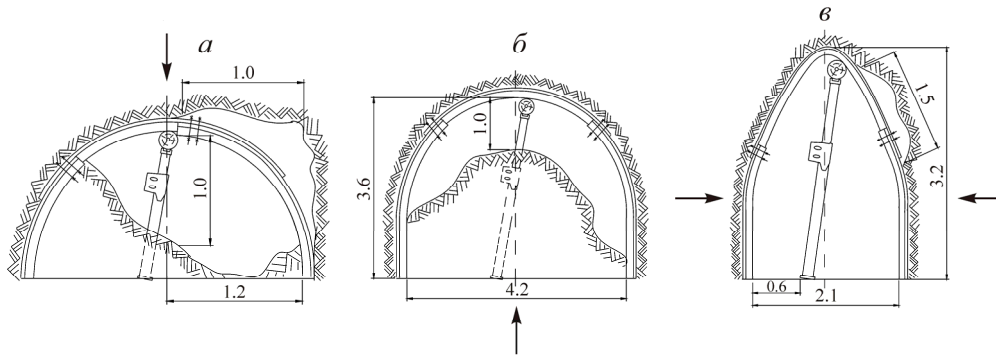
Нагрузки: а — со стороны кровли (смещение системы крепи, сколы на кровле); б — со стороны подошвы (вспучивание); в — со стороны боковых стен (смещение арки боковой стенки)
